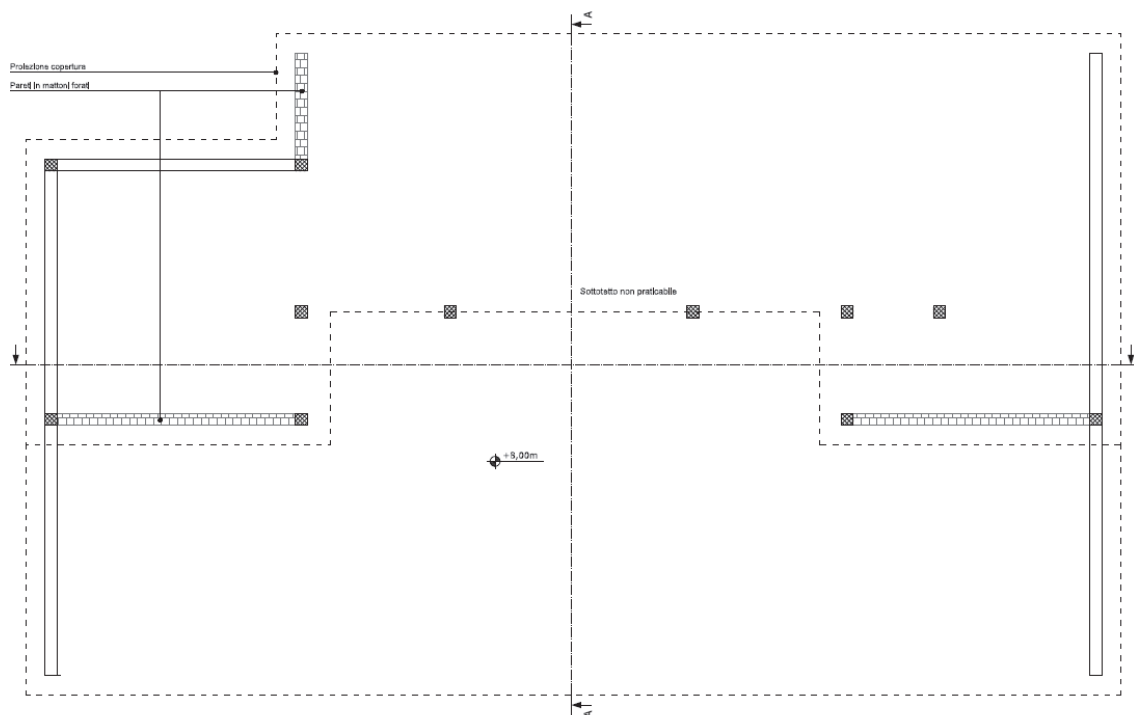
Pianta Piano Sottotetto dell'Edificio
